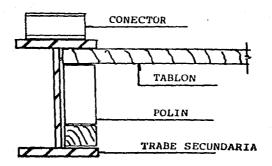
CIMBRA DE LA LOSA DE CONCRETO.
